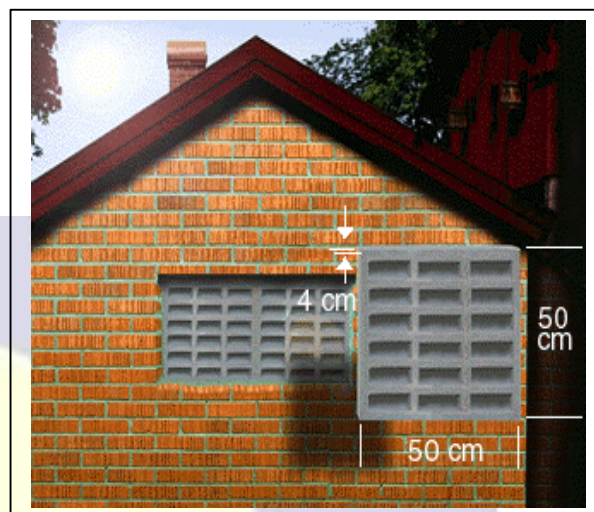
Elemento vazado de argamassa de cimento regular, tipo escama, 50,0 X 50,0 cm
